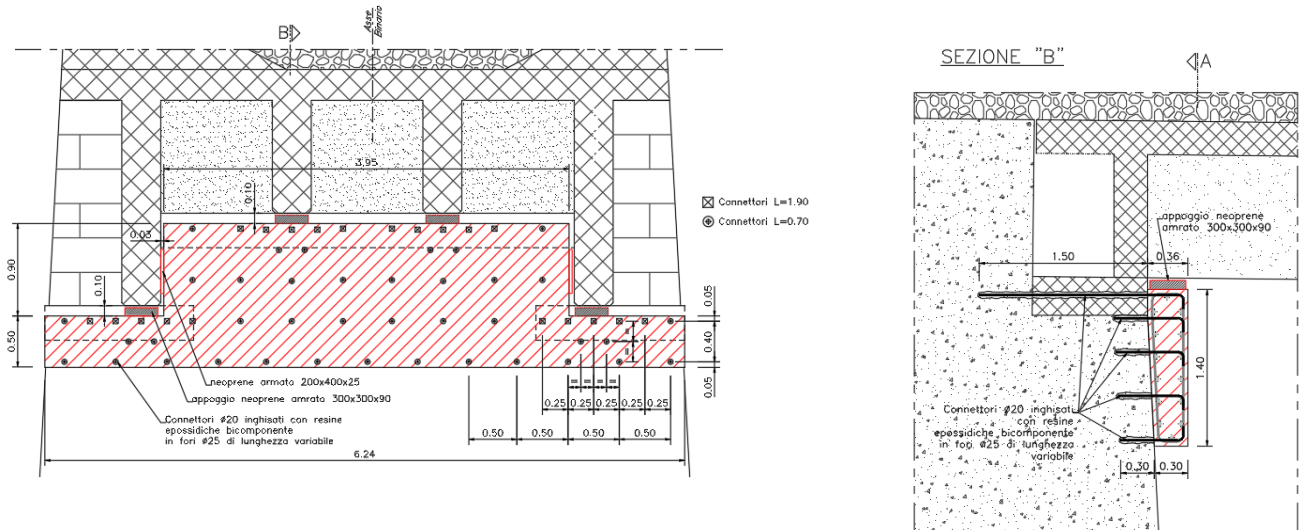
Dettaglio interventi sul muro frontale delle spalle;
